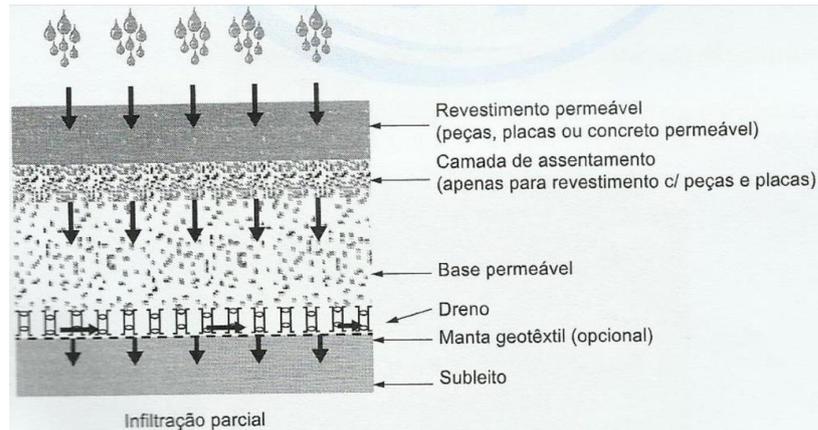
Sistema de infiltração parcial (NBR 16416).
